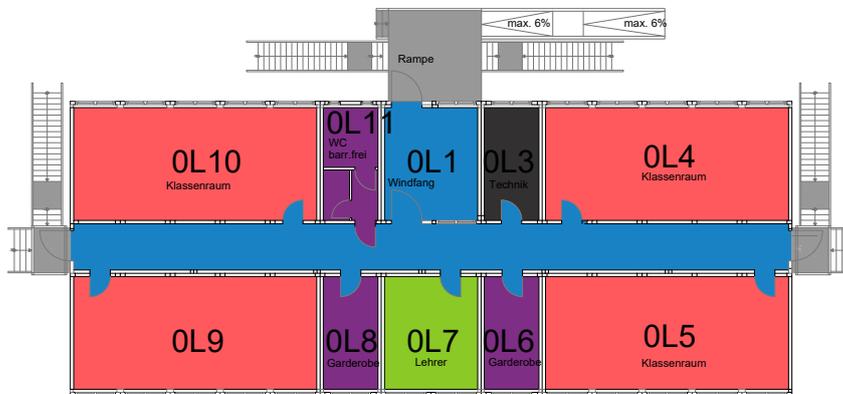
Hautgebäude, Obergeschoss (OG). Räume nach Belichtung und Nutzer:innengruppe eingefärbt
